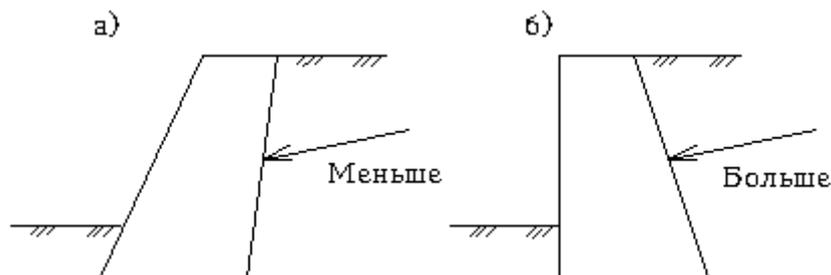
Влияние наклона задней грани стены на величину активного давления грунта на нее
